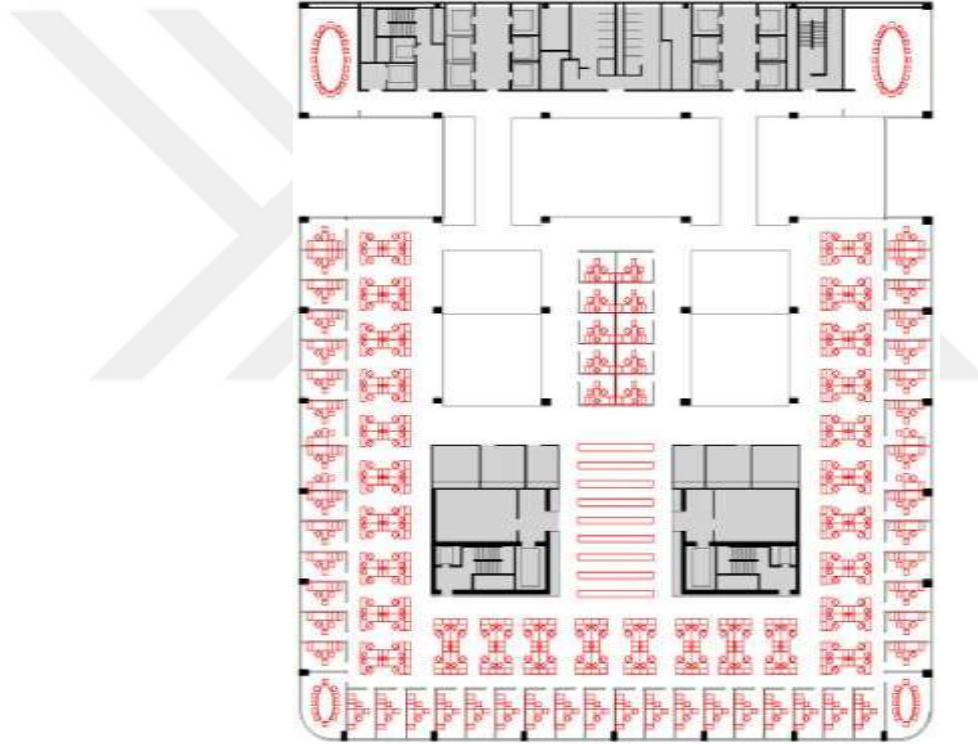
Gruner & Jahr Ofis Binası Planı (1985, Hamburg, Mim. Steidle and Kiessler) (Url-12).
